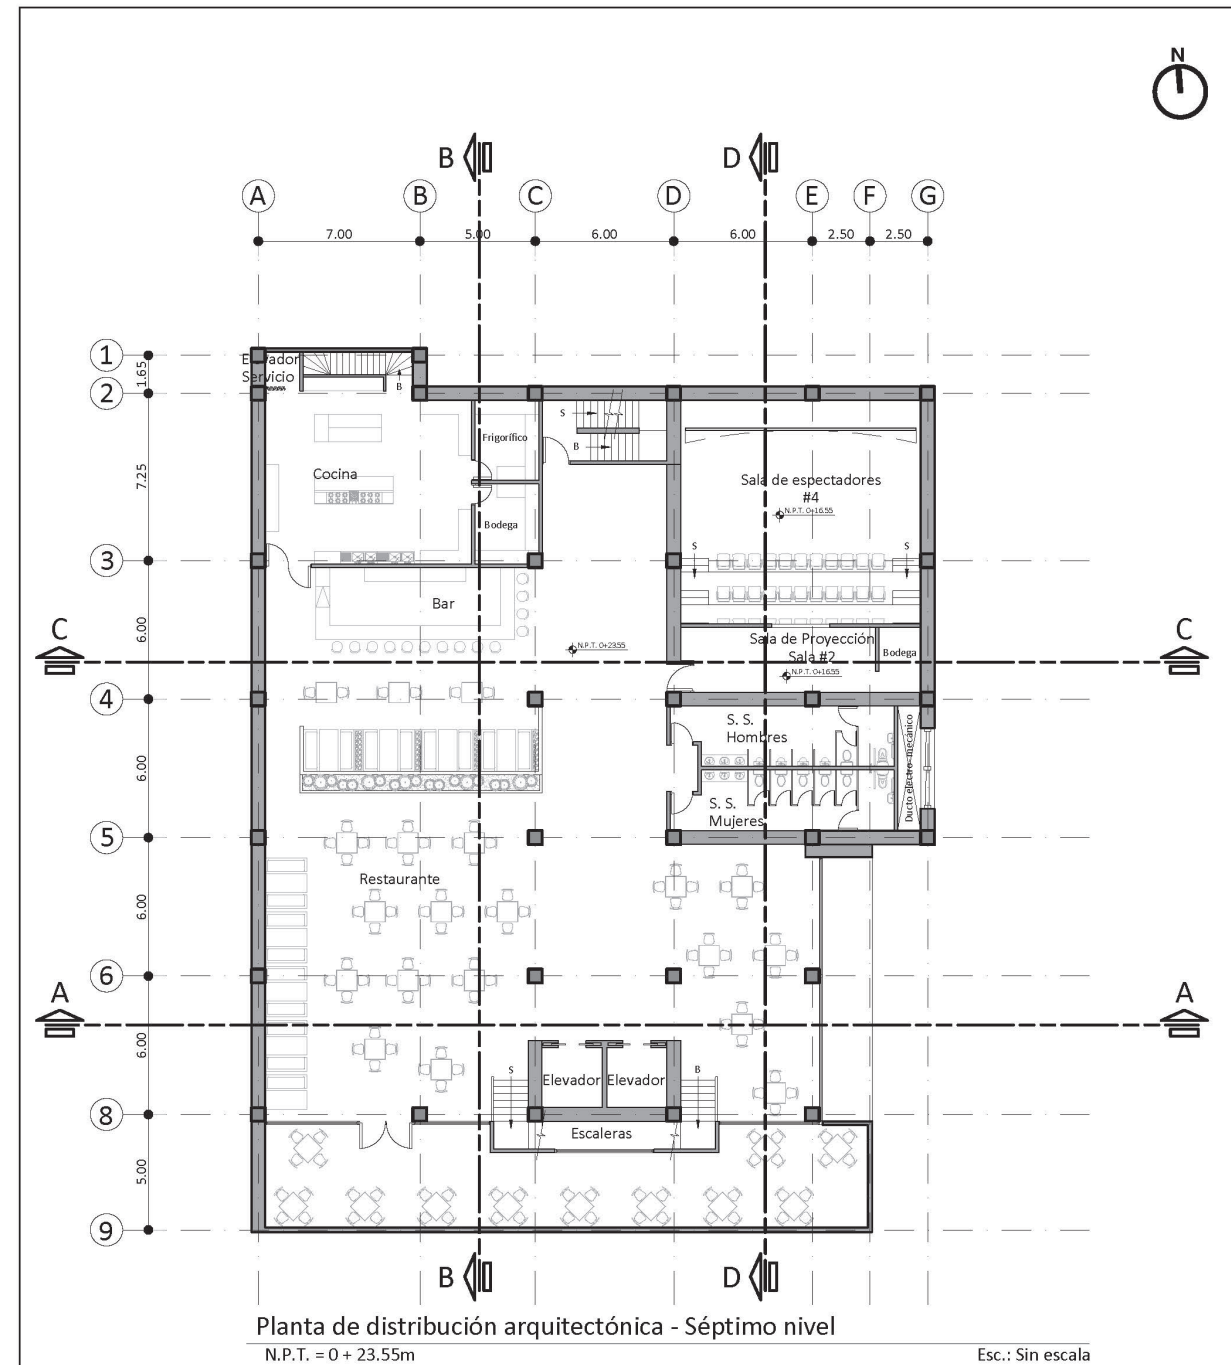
Planta de distribución arquitectónica de séptimo nivel. Fuente: Propia.
